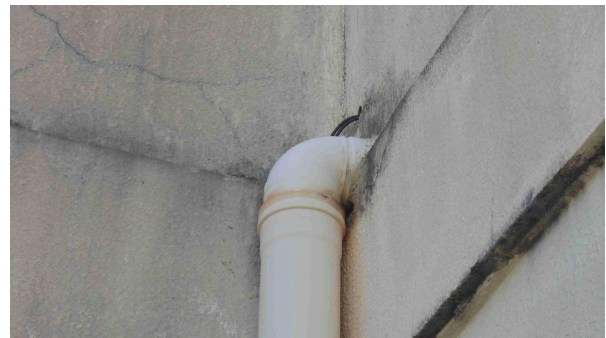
Detalhe da platibanda e do trecho inicial do condutor vertical em perfeitas condições, fazendo-se necessária a execução de pintura em tinta acrílica
